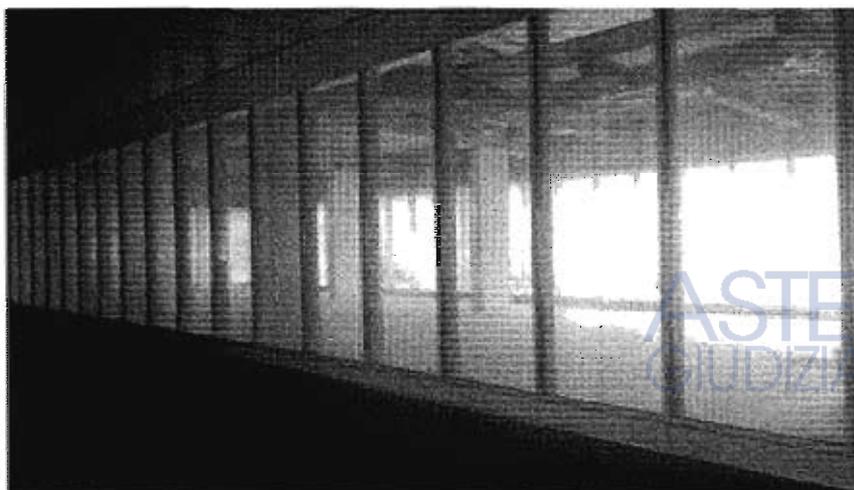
(P. Terra, vista dal corridoio interno libreria, identificata al sub 139)
